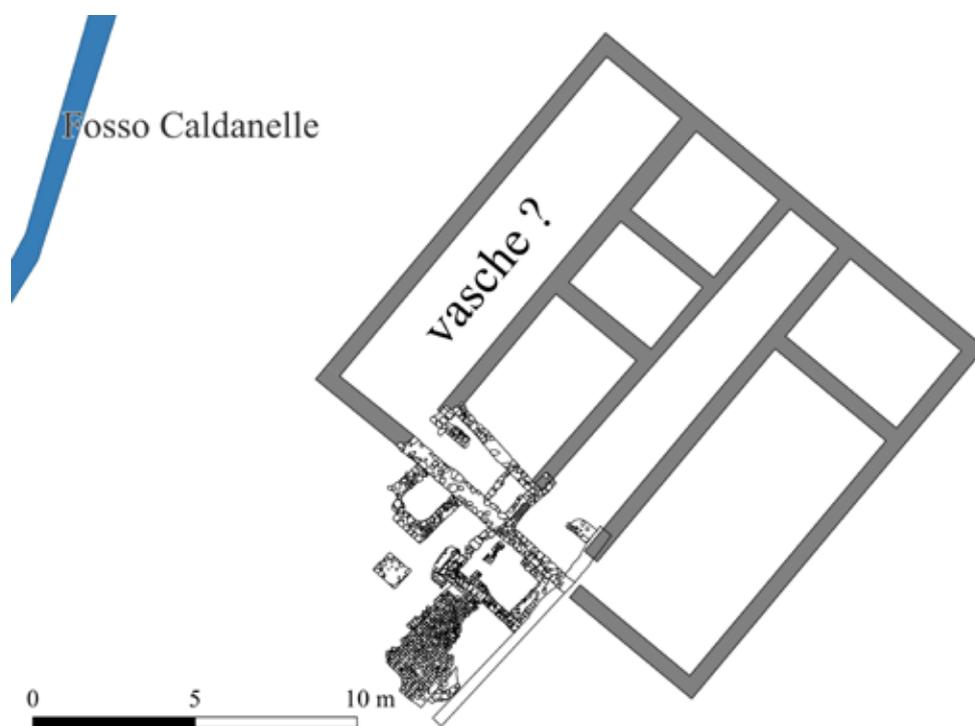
Planimetria del sito delle Caldanelle con la parte scavata e la ricostruzione dell'intero complesso attraverso le strutture parzialmente visibili (elaborazione Edoardo Vanni)
